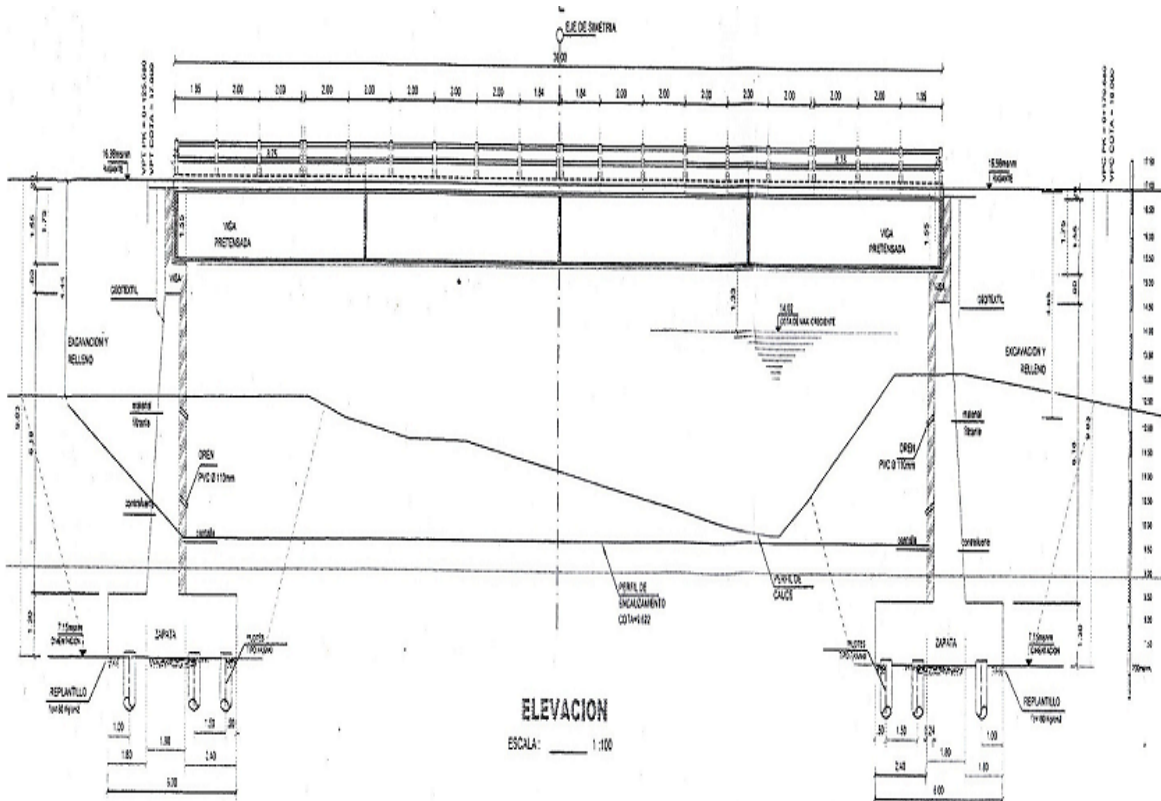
Vista en elevación del Puente PayPay Ecuador – Manabí
